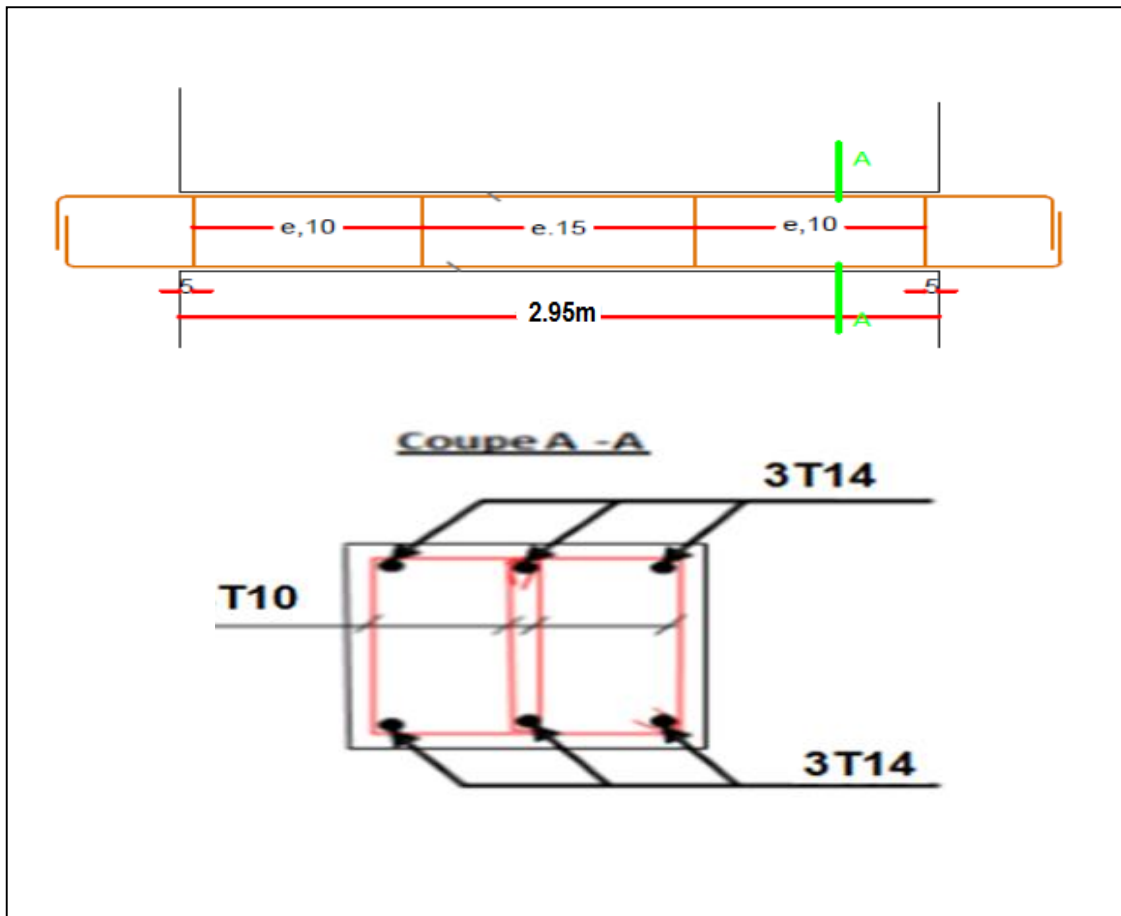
Schéma de ferrailage de la poutre palier.
